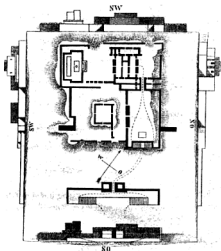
Grundriss und Aufriss des Palastes von Korsabad.
